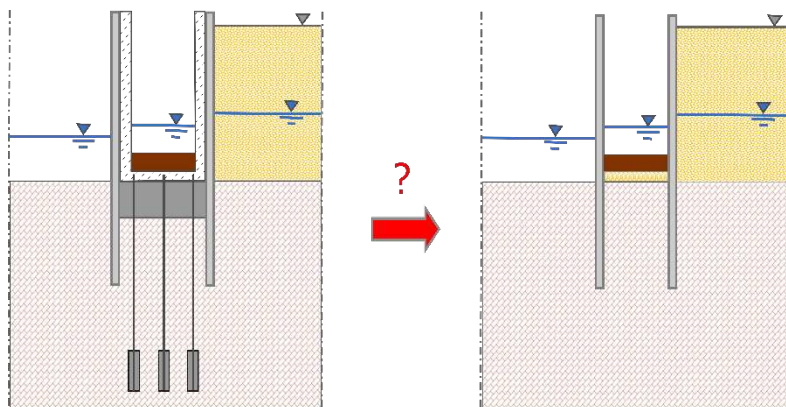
Schnitt durch ein Becken einer FAA in Schlitzpassbauweise. Vergleich zwischen der aktuellen Massivbauweise mit Betontrög und ggf. Rückverankerung zu einer im Projekt untersuchten Bauweise mit offener Sohle ohne Betontrög.
